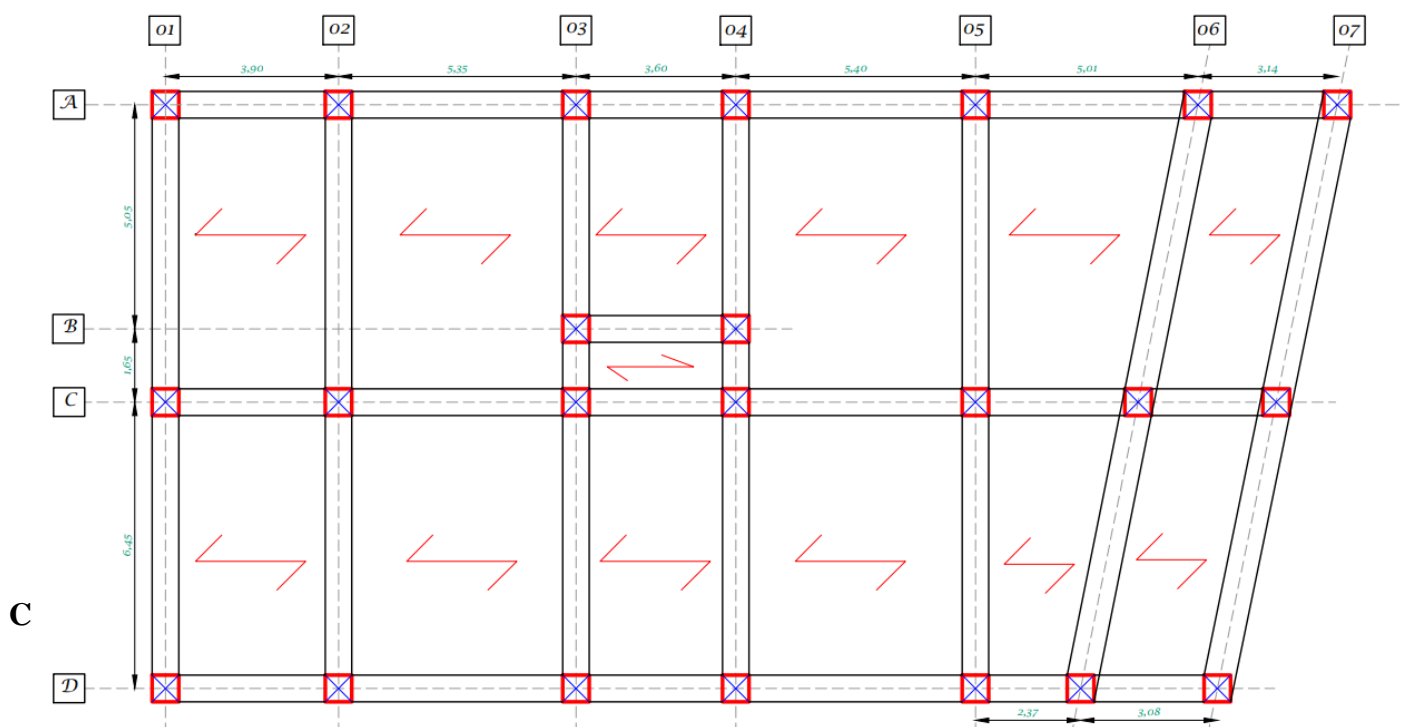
Plan de disposition des poutrelles entre sol et RDC, étage 01.
